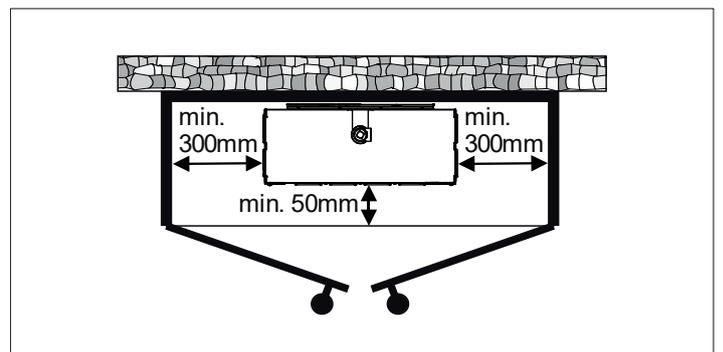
Mindestmaße für den Einbau des Dampferzeugers in einen belüfteten Schrank
